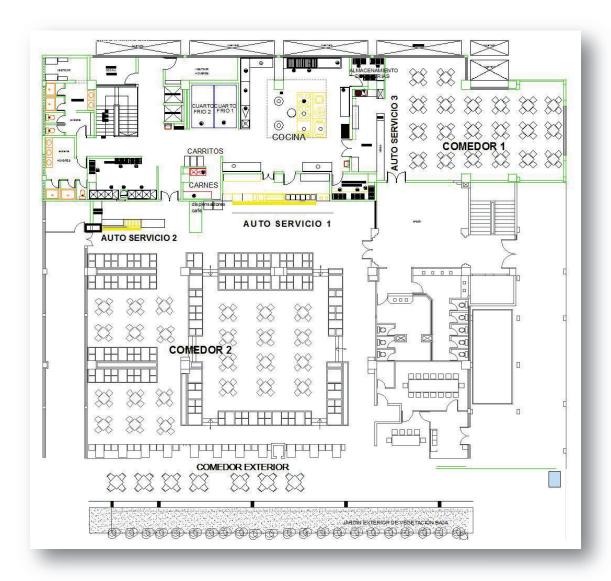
Esquema arquitectónico de la planta alta del comedor de la EPN (Departamento de planificación EPN)
